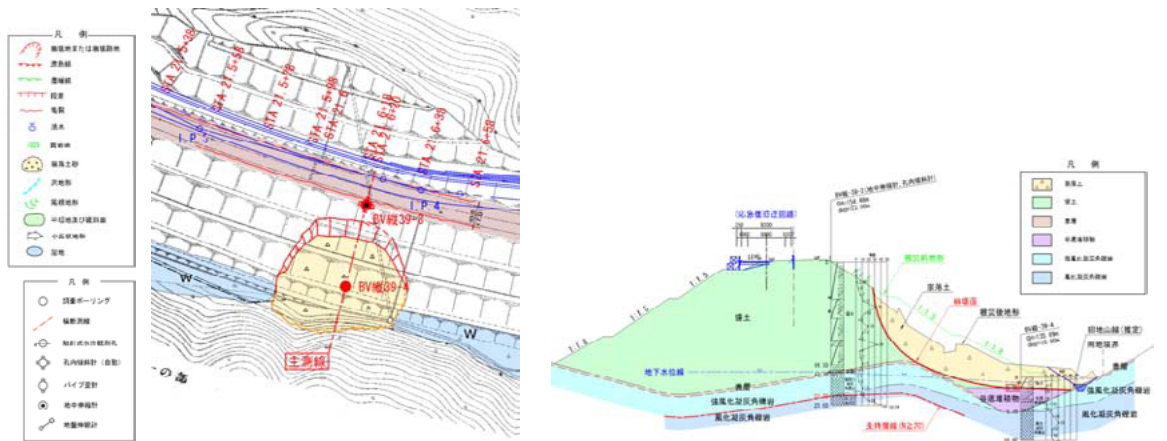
崩壊箇所平面図及び主断面図 その2 (能登有料 穴水町越の原その2 21.6kp 縦-39) ²⁾
